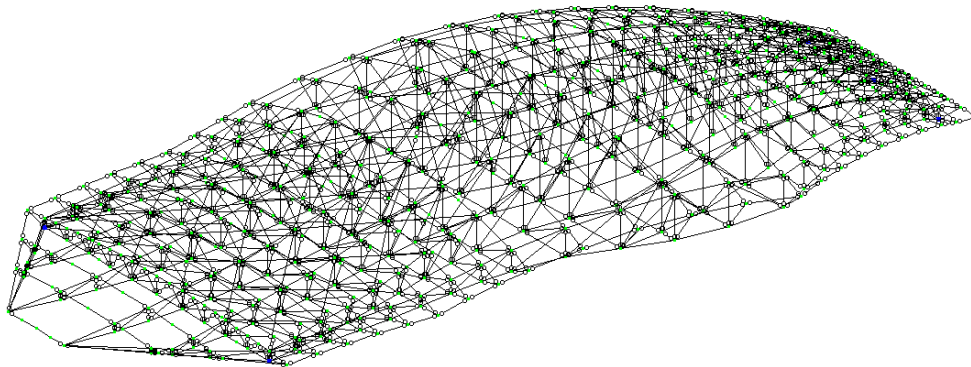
Пространственная стержневая конструкция покрытия 1 вариант
